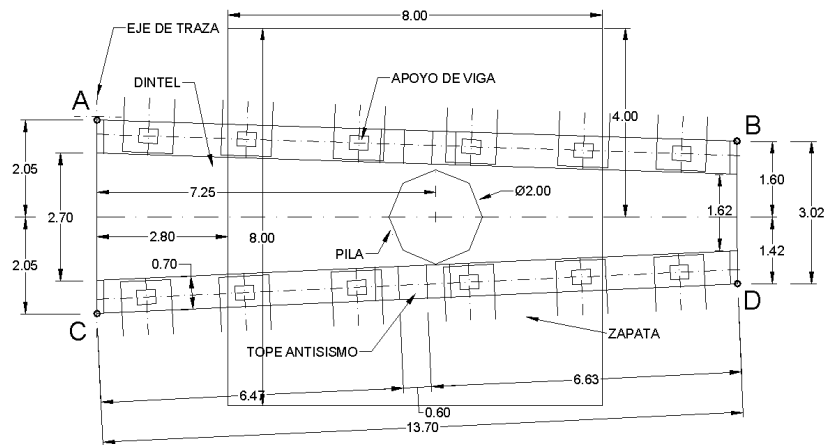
Vista en planta de la viga cabezal de Pila 8
